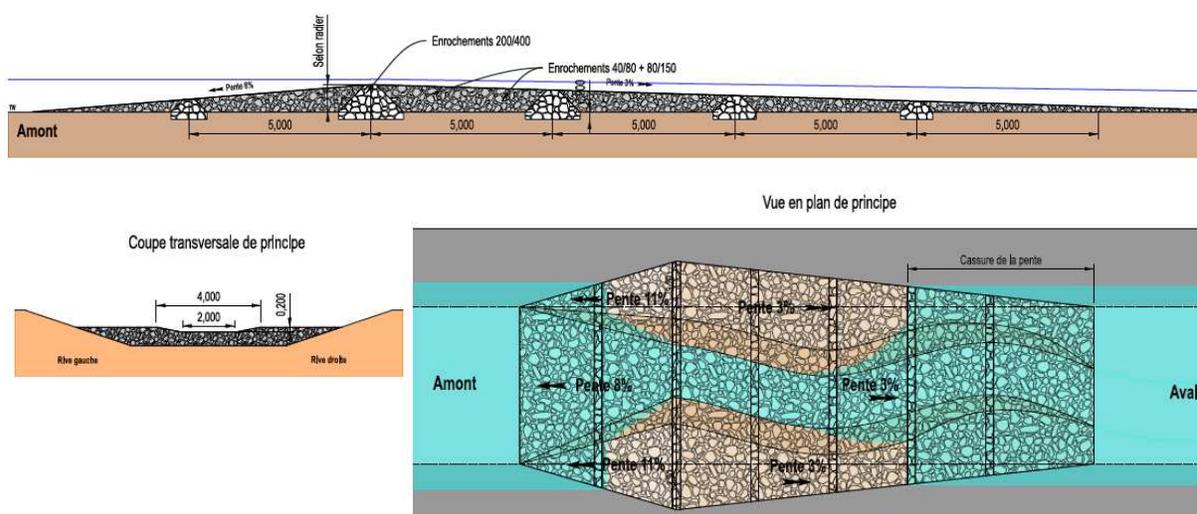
coupes de principe et vue en plan des radiers (plan n°16)
